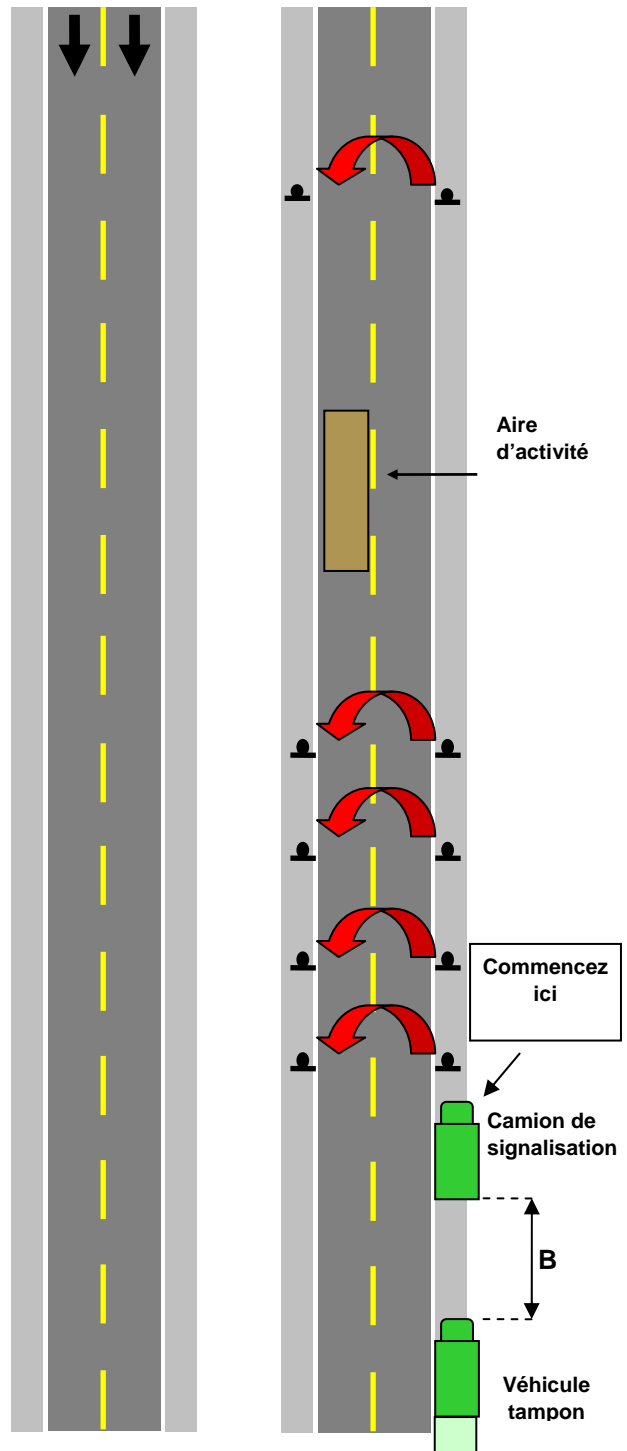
Installation des panneaux (routes à voies multiples à chaussées séparées)
